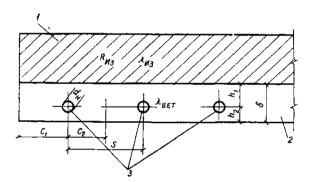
24 Расчетная схема сплошной железобетонной плиты перекрытия
